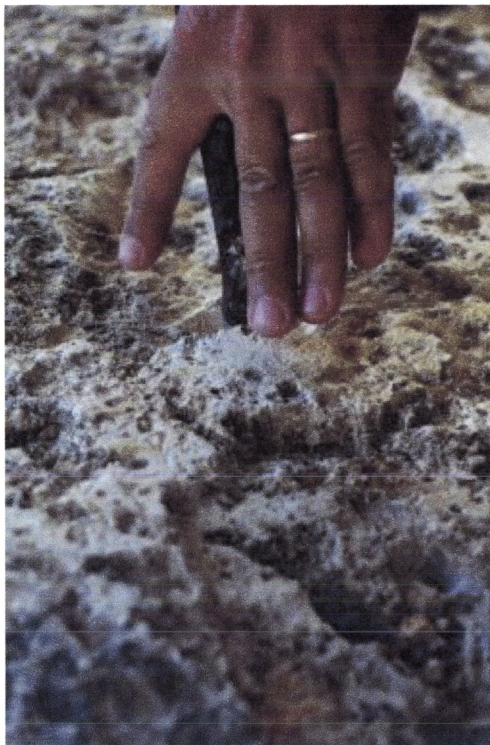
Castelo de Moura, muralha, local de extracção da amostra de revestimento para posteriormente ser analisada no LNEC (foto da autora)
